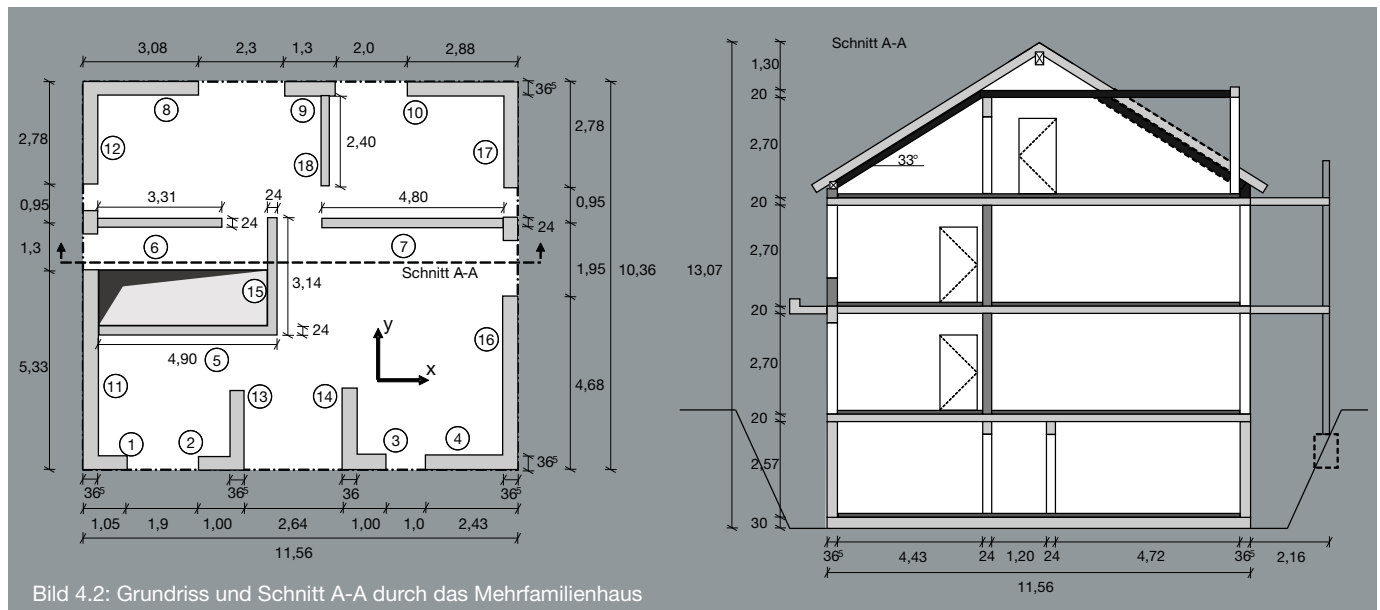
Grundriss und Schnitt A-A durch das Mehrfamilienhaus
